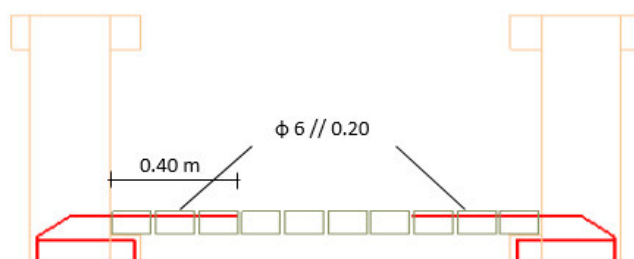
Modelação da ligação entre as vigas e laje do tabuleiro.
